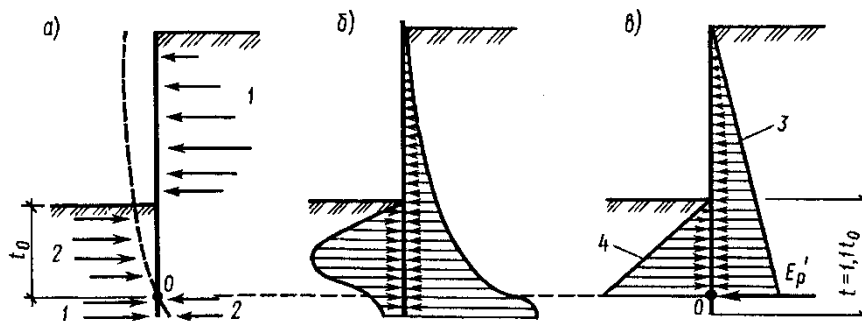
Работа безанкерной шпунтовой стенки:
